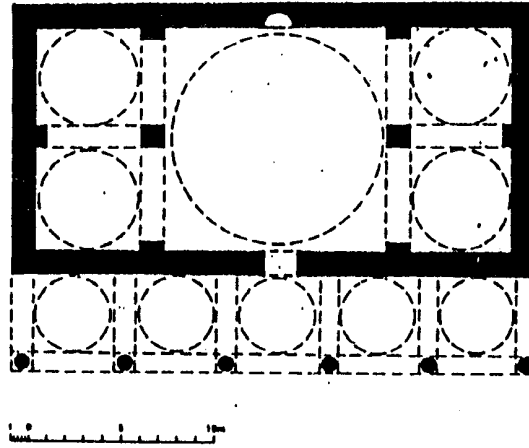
مسقط أفقي للمدرسة الاشرفية الكبرى بتعز باليمن
